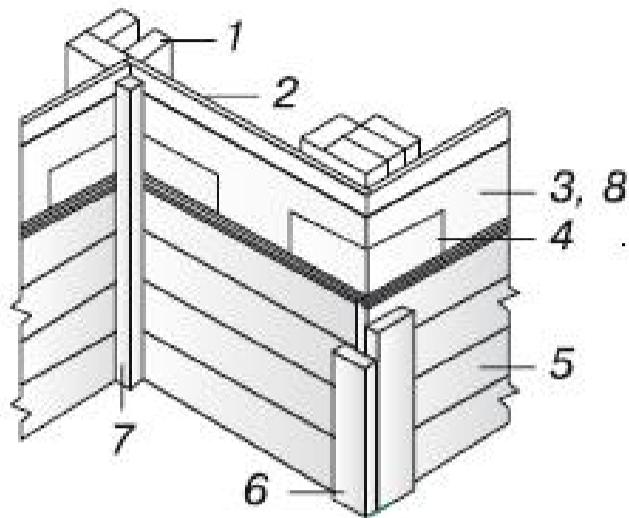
Монтаж погонажного сайдинга: 1 – вертикальная обрешетка; 2 – контробрешетка; 3, 8 – полосовая гидропароизоляция; 4 – фартуки из кровельной стали; 5 – рядовой сайдинг (горизонтальный и вертикальный); 6 – наружный угол; 7 – внутренний угол
